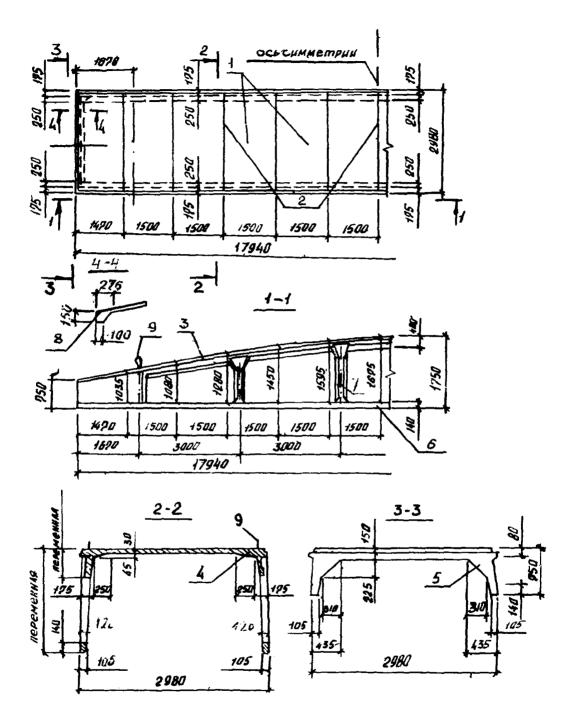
Глухая складчатая панель-оболочка КСО 3х18м 1-грани складчатой полки: 2-ребра складчатой полки: 3перраскосная ферма-диафрагма: 4-рутовая часть полки: 3-1-горцовые вуты: 6-нижний пояс: —стойки: 8-торцовые ребра; 9-падающие петли для подъема
